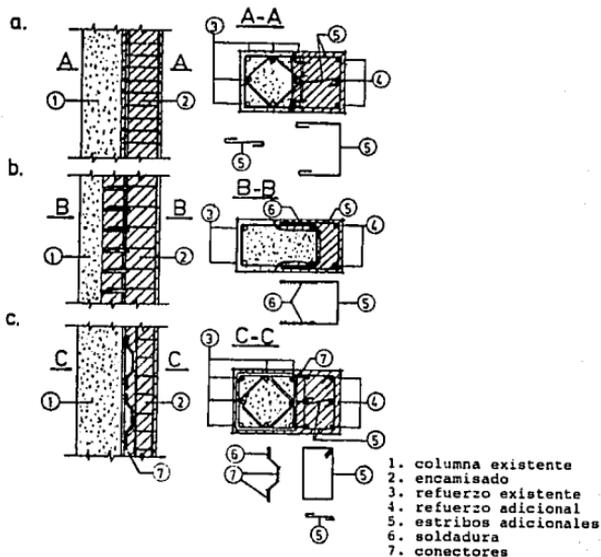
Encamisado parcial de columnas utilizando concreto reforzado.
